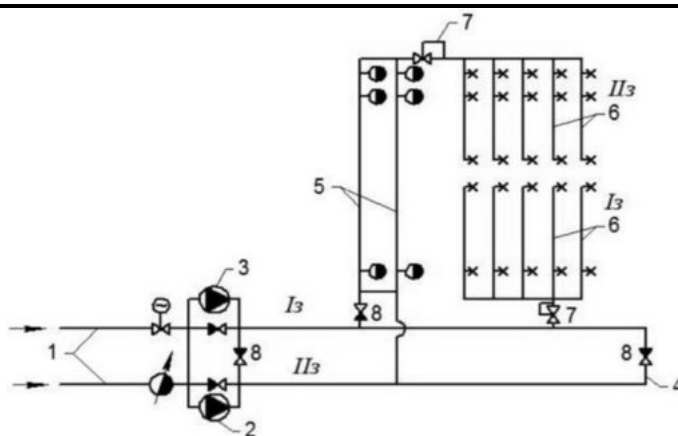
Двухзонная схема водоснабжения зданий: 1 – вводы водопровода; 2 – хозяйственный насос второй зоны; 3 – противопожарный насос; 4 – перемычка между подводящими магистральными трубопроводами; 5 – пожарные стояки; 6 – хозяйственные водоразборные стояки; 7 – регулятор давления; 8 – обратный клапан
